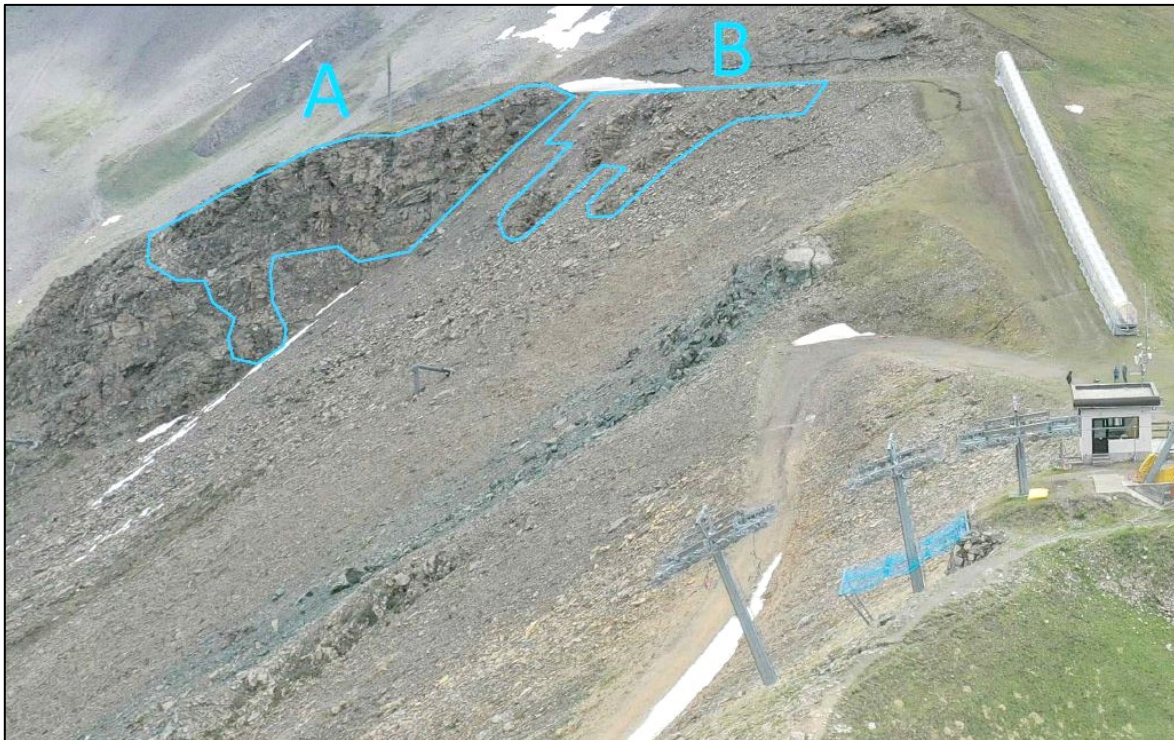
VISTA SETTORI A E B OGGETTO DI RIVESTIMENTO CORTICALE
